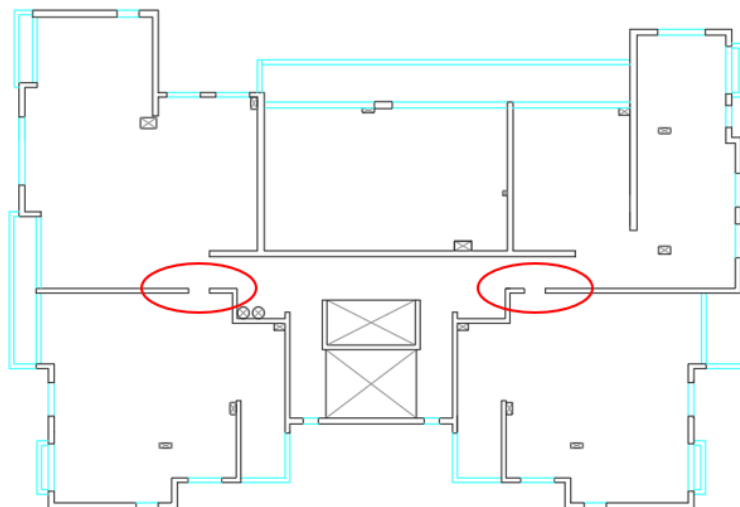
Ubicación general en planta de daño por acción de acoplamiento en losas.
